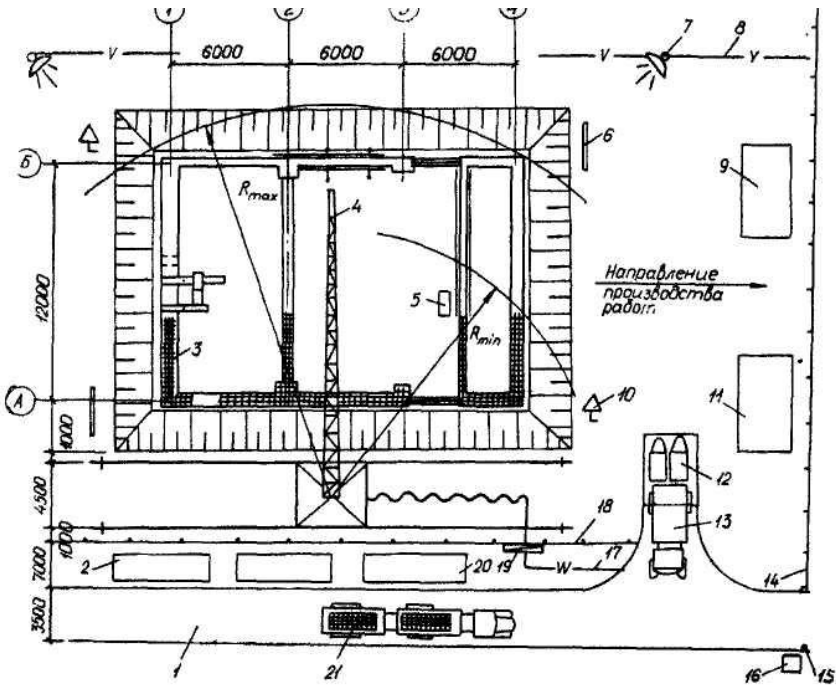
Технологическая схема производства опалубочных, арматурных и бетонных работ:
